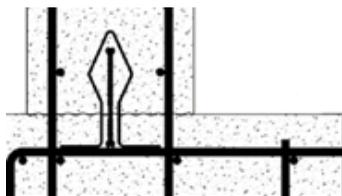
РШБ с гидрошпонкой. Стык стены и фундамента с гидроизоляцией.
